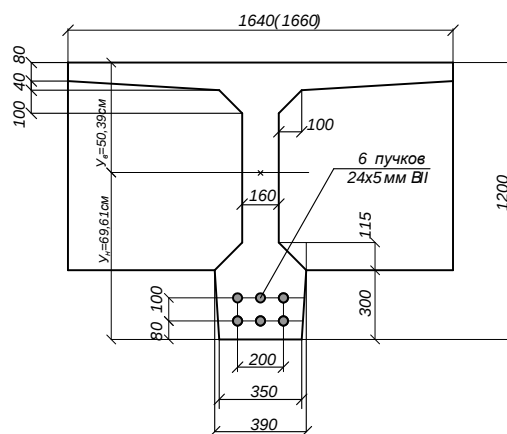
Поперечний переріз середніх балок прогонової будови довжиною 22,16 м
